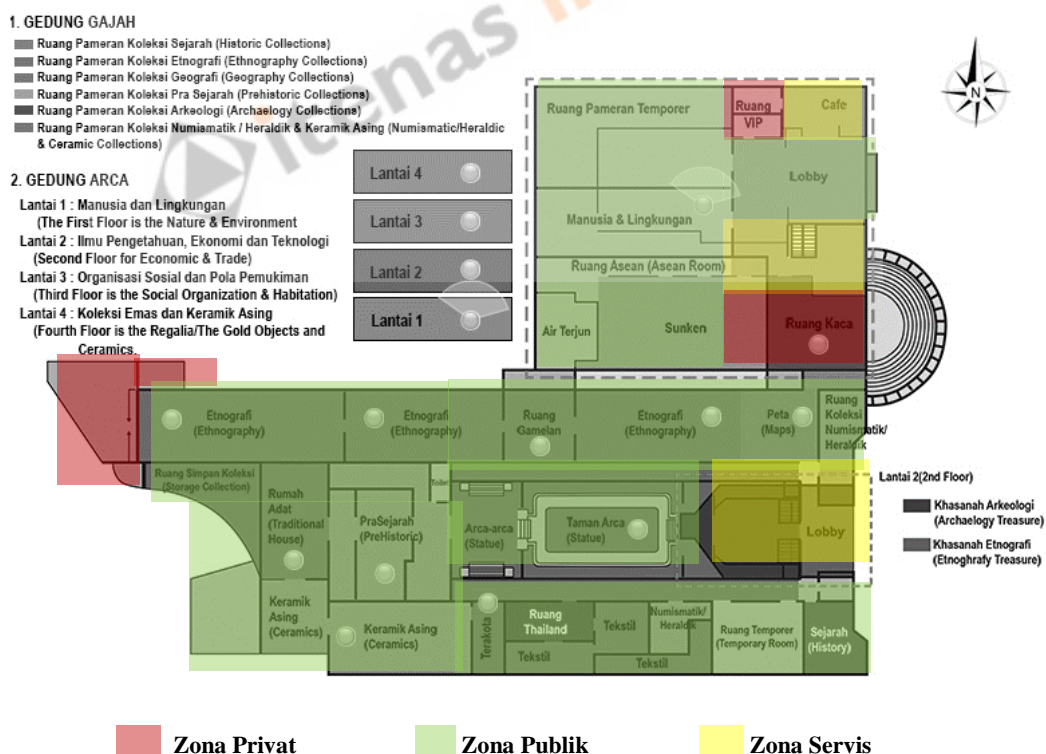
Denah Gedung Arca dan Gedung Gajah
